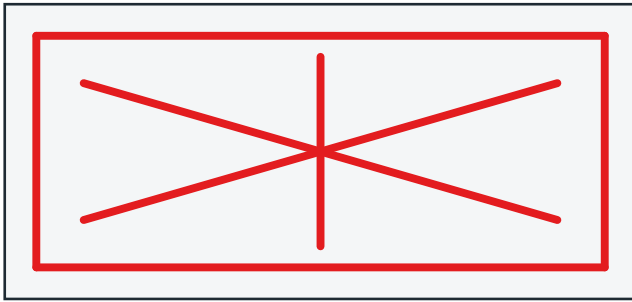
Anordnung der Bewegungsfugen im Grundriss.
